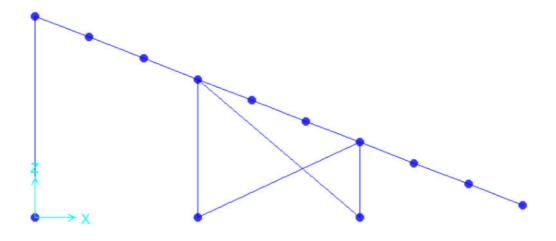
Modello SAP2000 struttura – Sezione longitudinale
